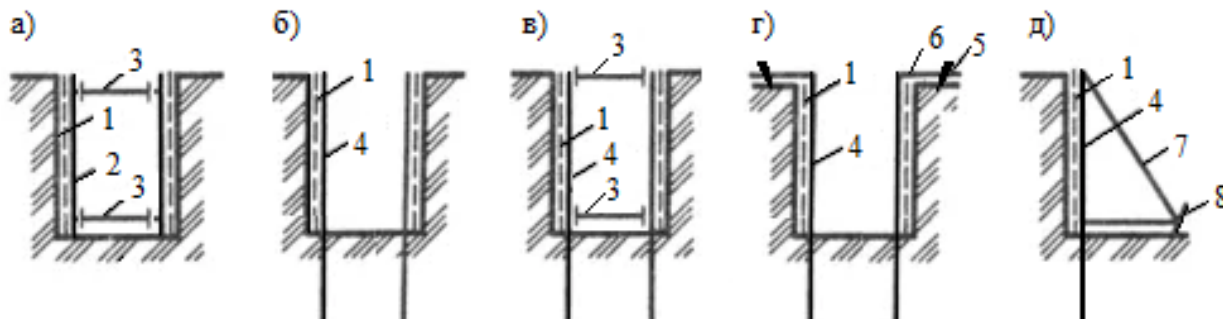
Схемы конструктивных решений креплений стенок траншей:
